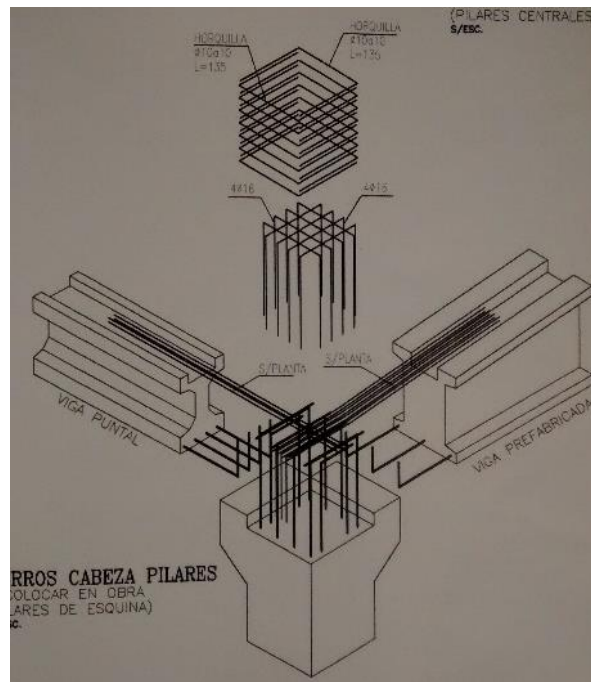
Detalle de conexión pilar – viga, ejemplo 2.
